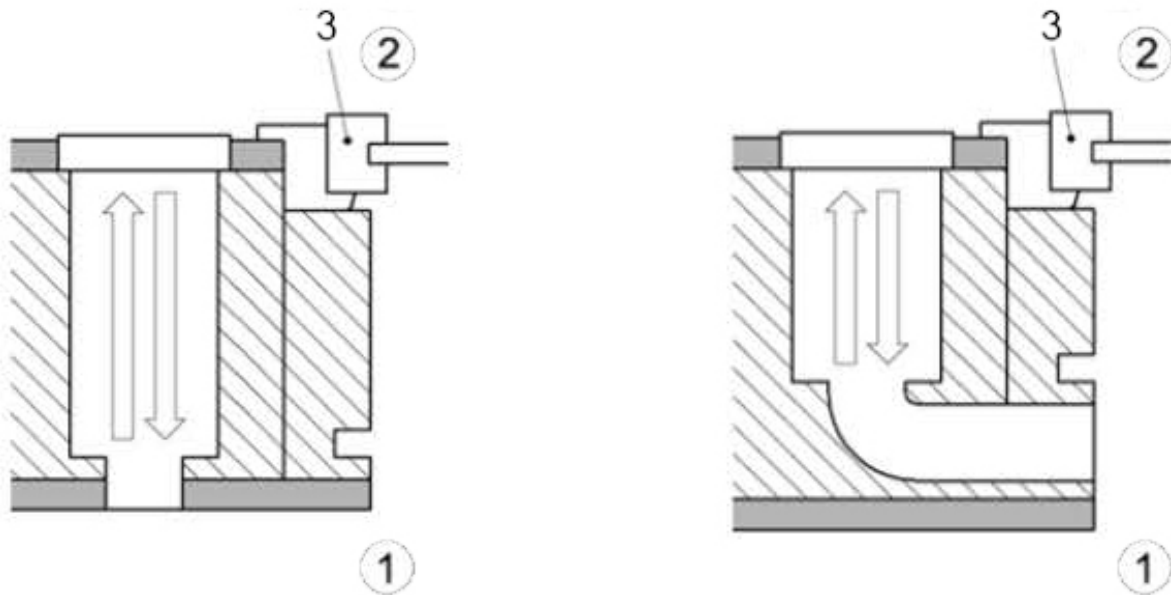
Sezione verticale - Esempio di dispositivo di ventilazione inserito superiormente tra il telaio fisso del serramento ed il vano di posa (a sinistra) ed inserito a parete (a destra)
